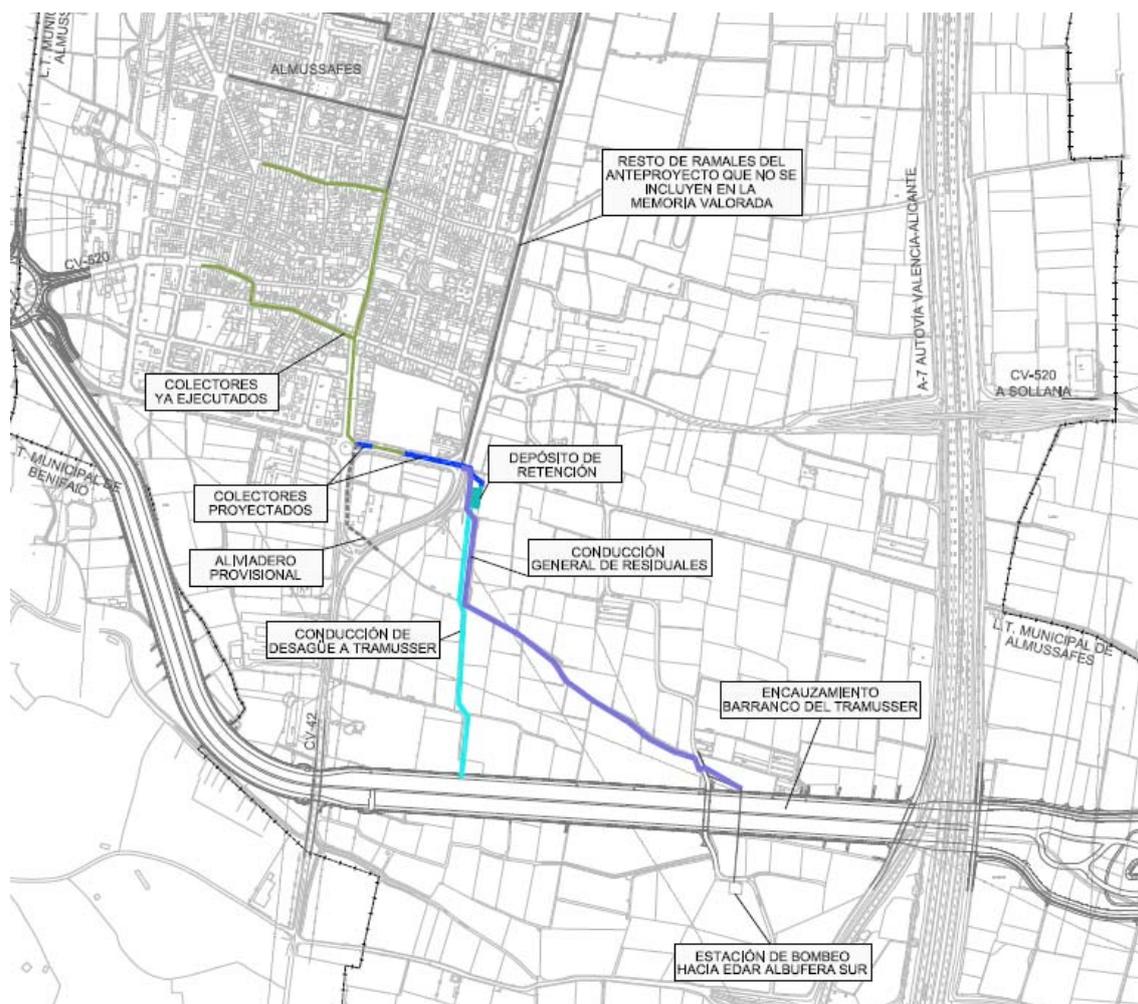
Emplazamiento de las actuaciones previstas en el anteproyecto de TYP SA (2013).
